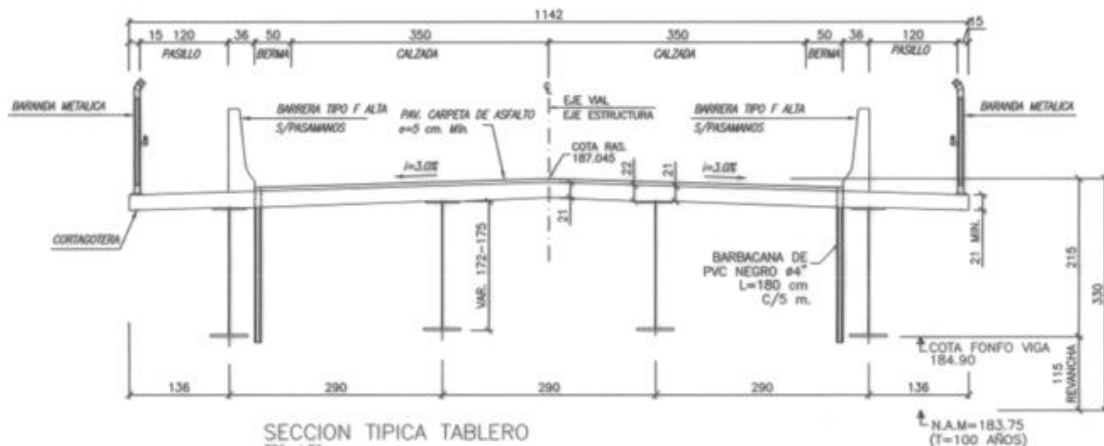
Plano sección transversal típica tablero Puente Rubens.
